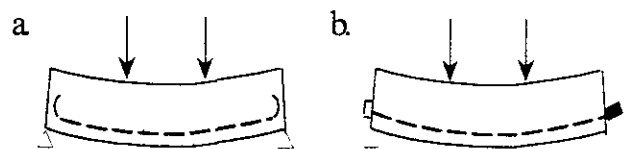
Deformación y agrietamiento en vigas de:
